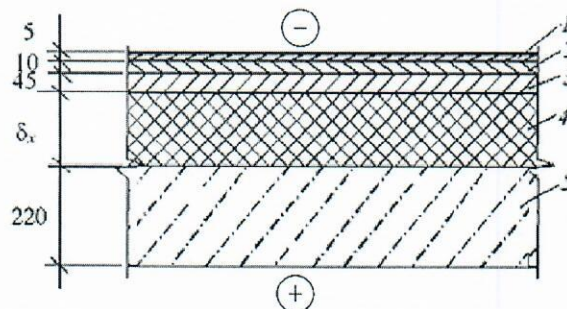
Вариант 1-й конструкции перекрытия над неотапливаемым подвалом:
